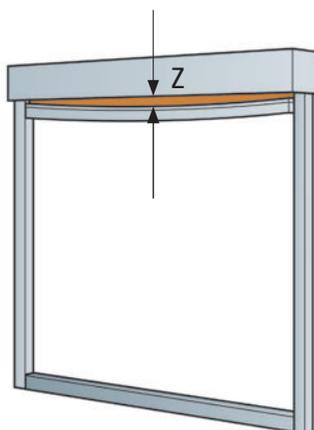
Espace entre la barre de charge et le caisson du store banne dans la zone centrale
